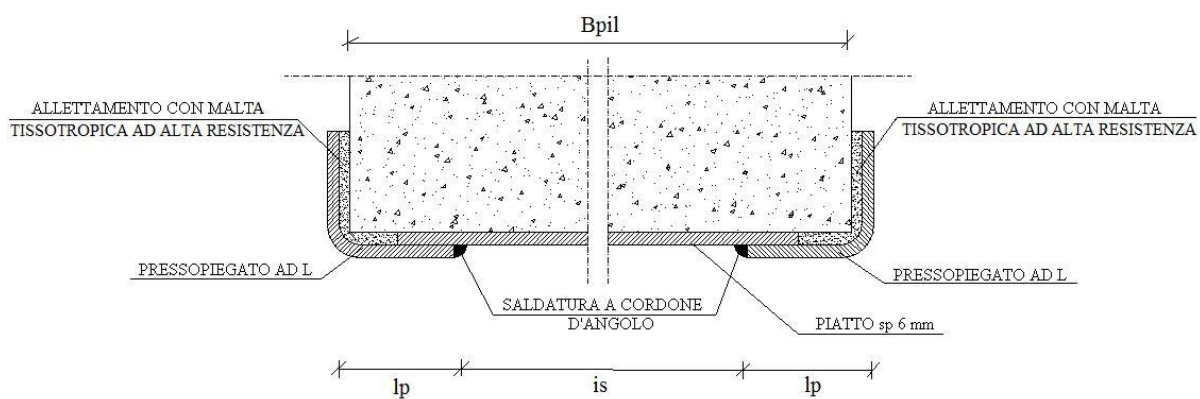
Vista in sezione in testa al pilastro dello schema di cui alla Figura A3
